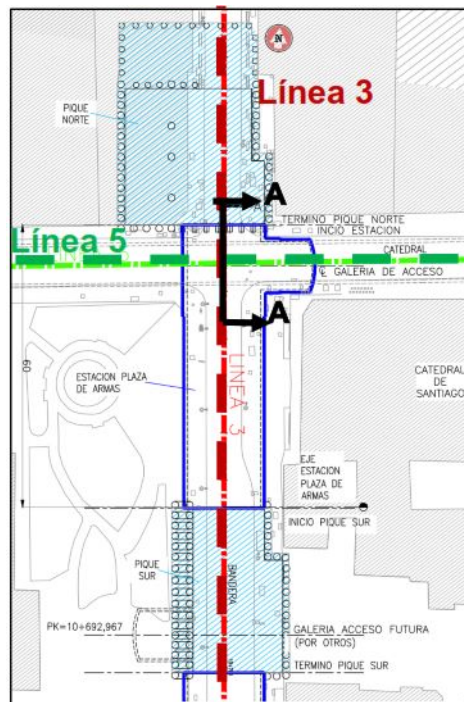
Vista en planta cruce estación Plaza de Armas
